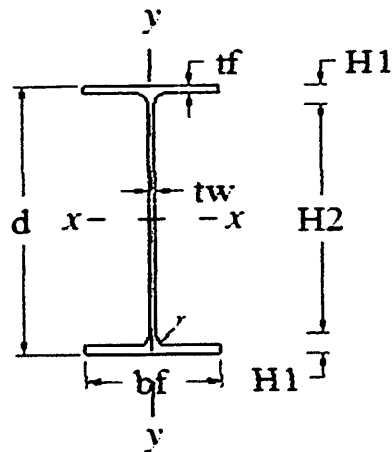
Penampang Kolom Baja (Profil Kingcross)
